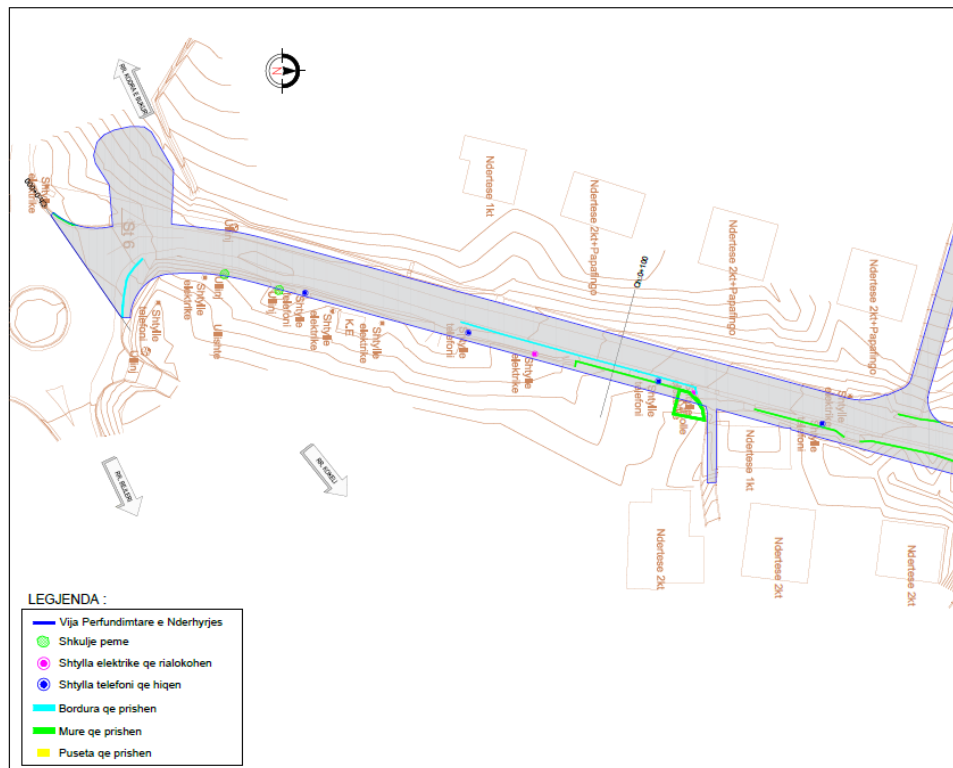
Pjesë nga Planimetria e Nderhyrjeve
